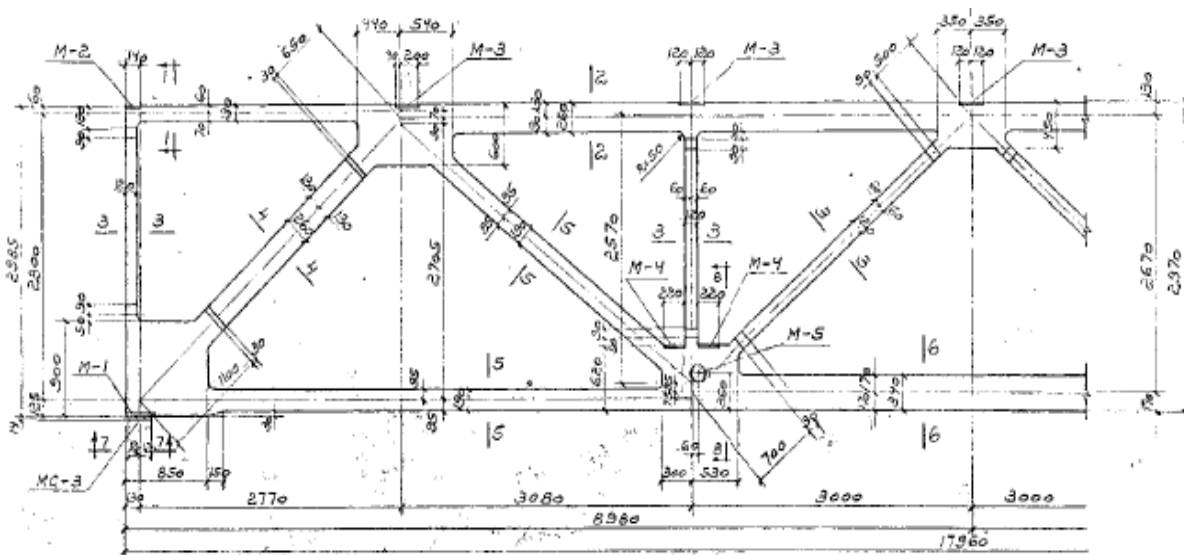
Конструктивная схема железобетонной фермы с параллельными поясами.
